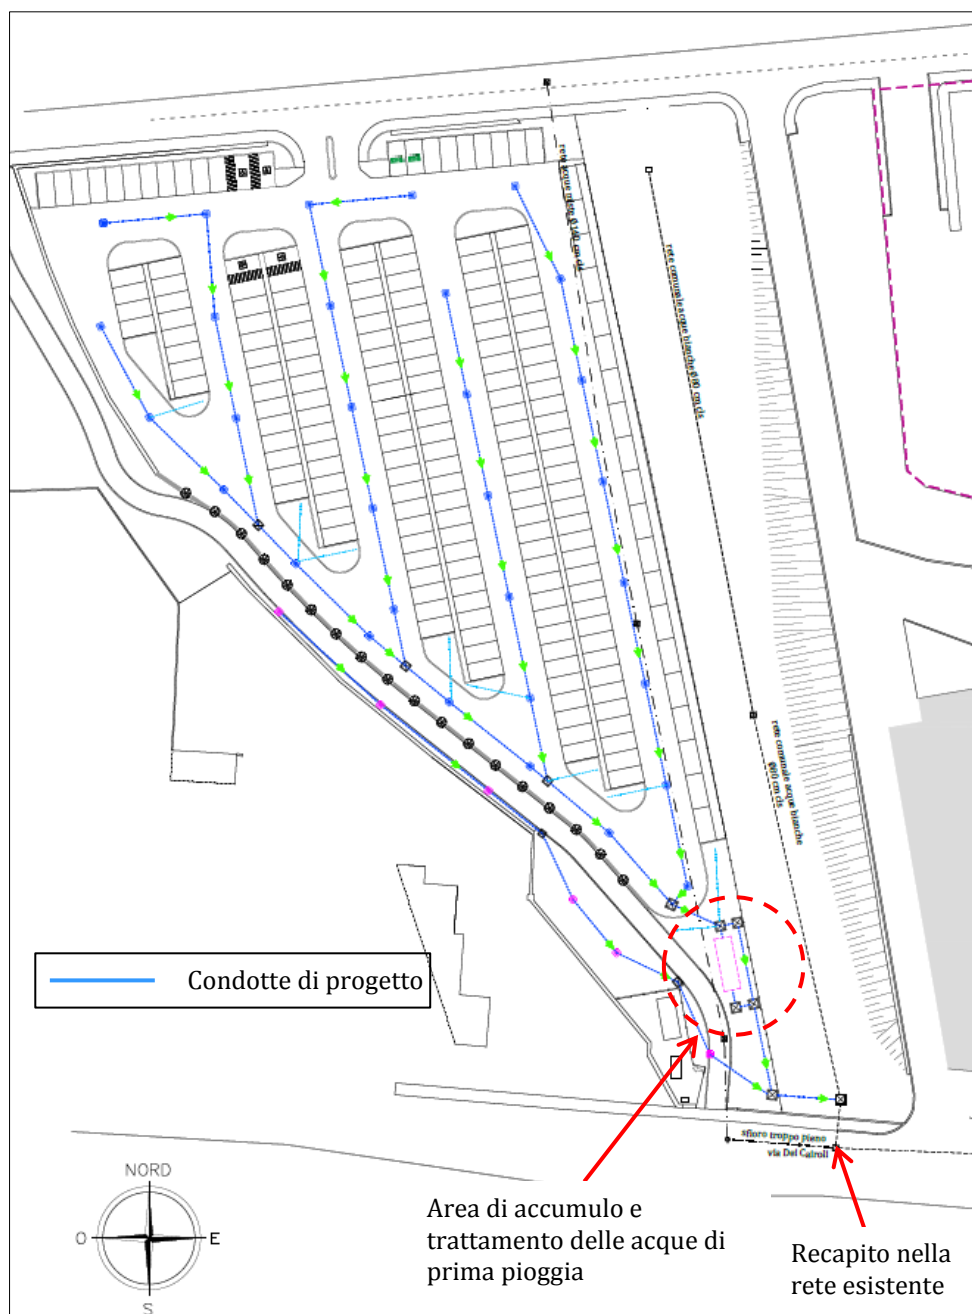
Schema planimetrico rete di drenaggio lotto A.
